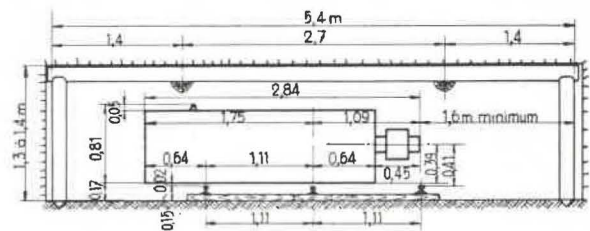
Encombrement de l'auger-Drill Joy AD<sub>2</sub> et section du montage de départ.
